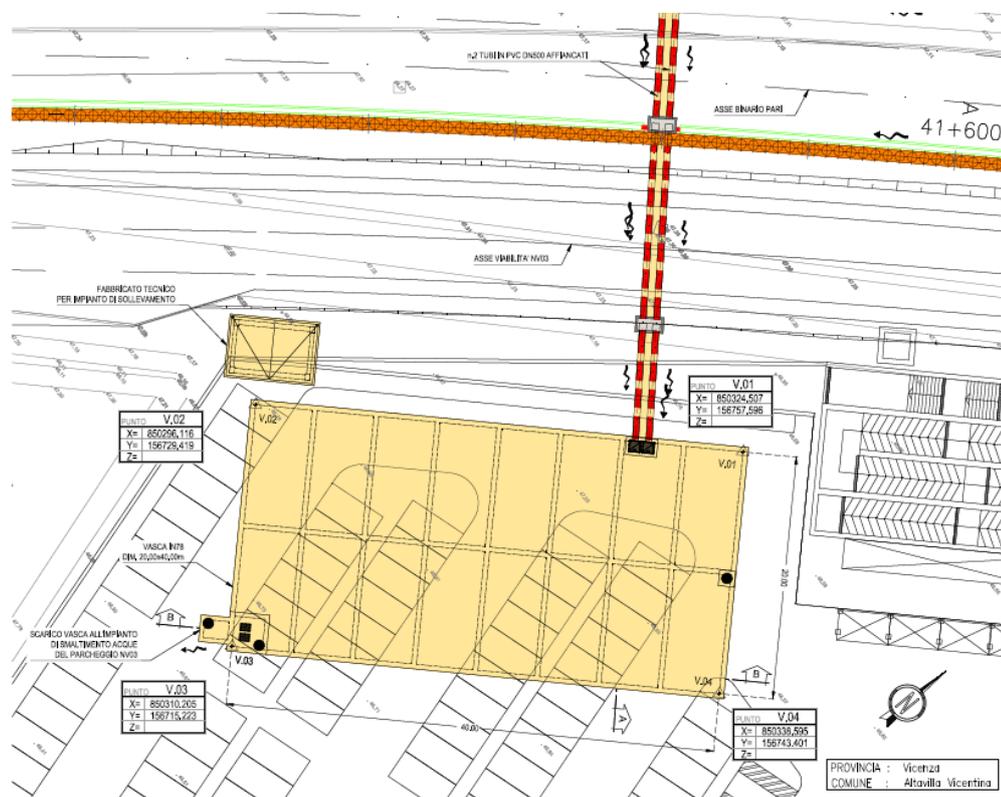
Planimetria di progetto della vasca di laminazione e sollevamento
